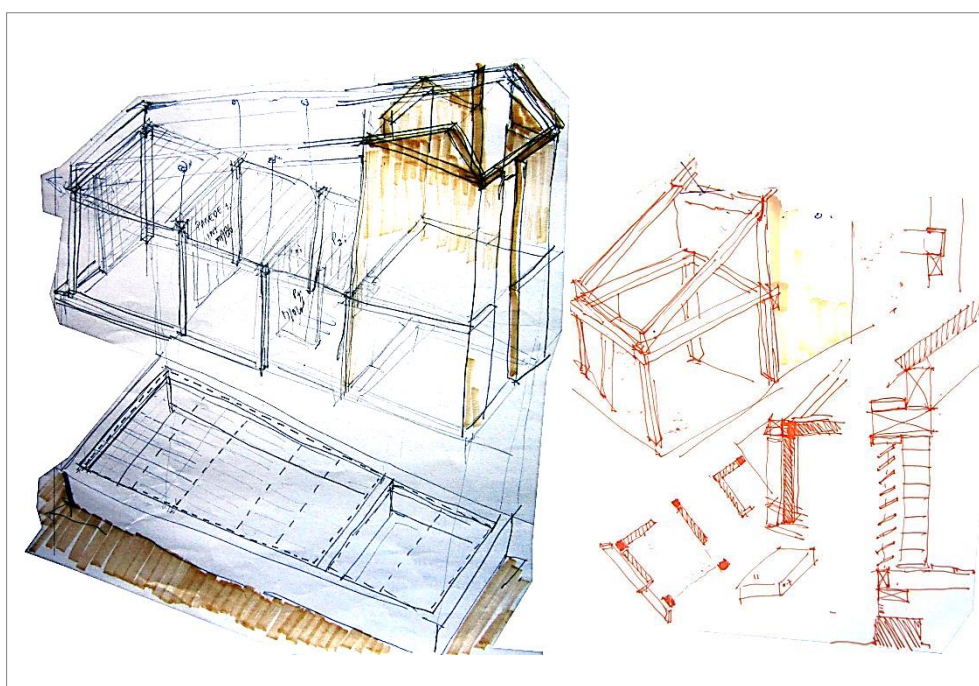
| ESTRUTURA. FACHADA EM RIPADO DE MADEIRA
